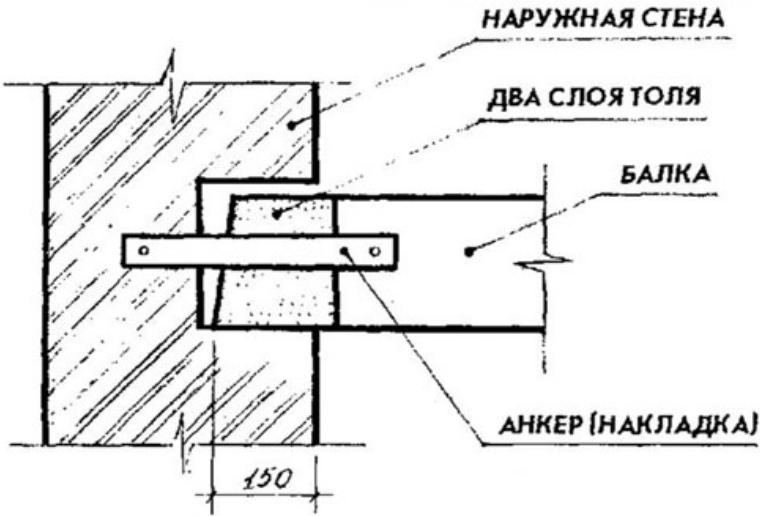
Пример опирания деревянной балки на кирпичную стену
